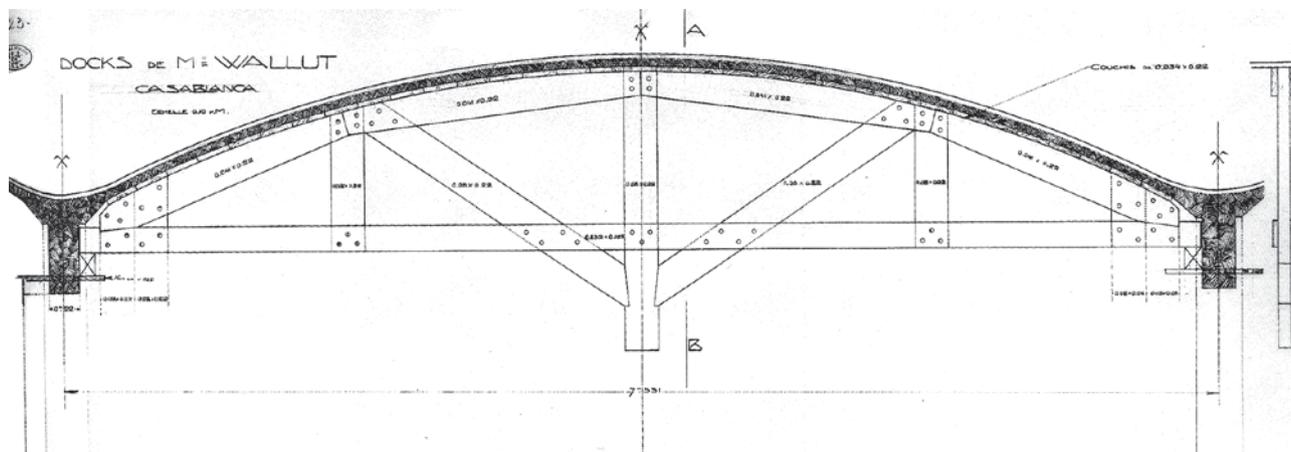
Armazéns Wallut, Casablanca, Marrocos, 1914-17. Detalhe do cimbramento. (COHEN, 2002, p.93).
